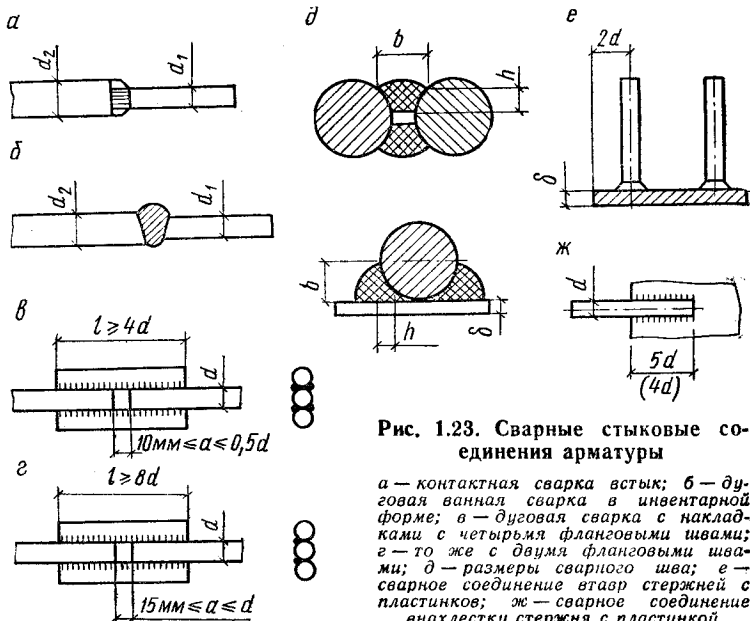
Сварные стыковые соединения арматуры
